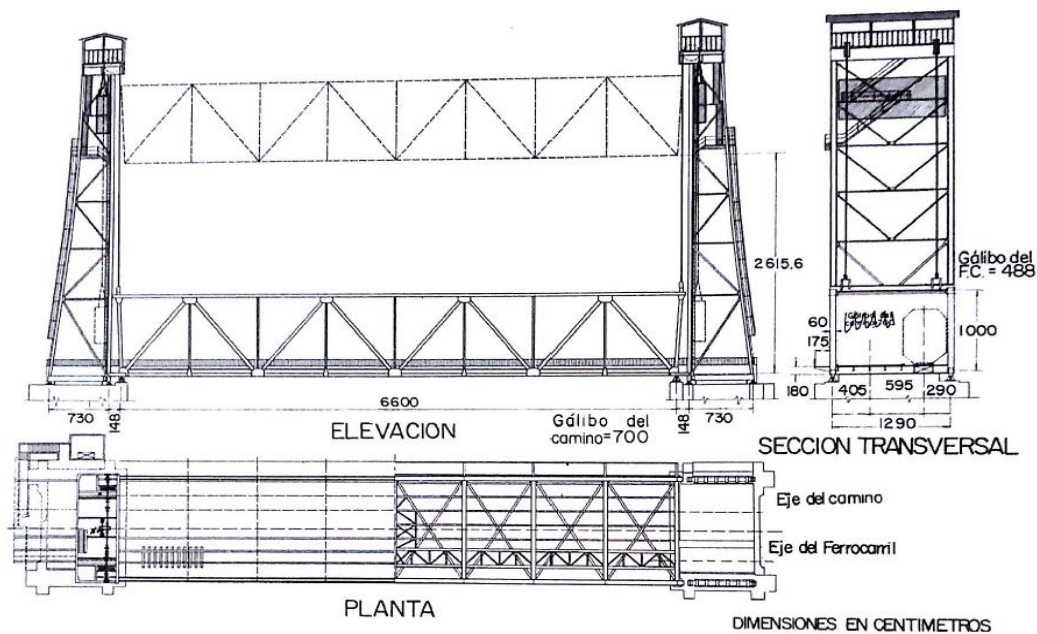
Detalle del tramo metálico levadizo [1.2].
